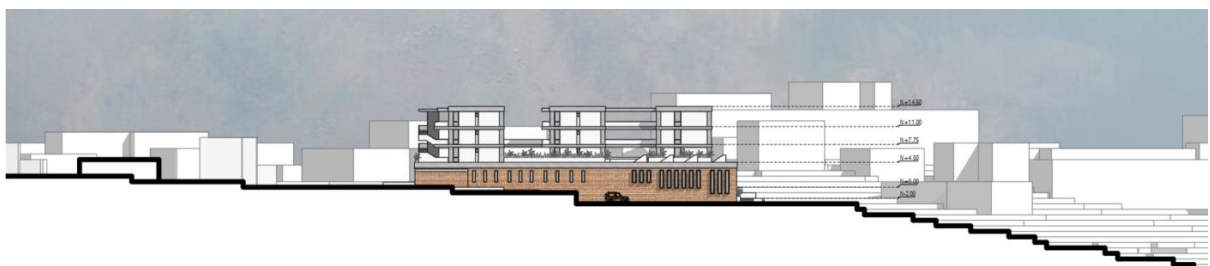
Elevación sur - Proyecto definitivo. Elaboración propia.
